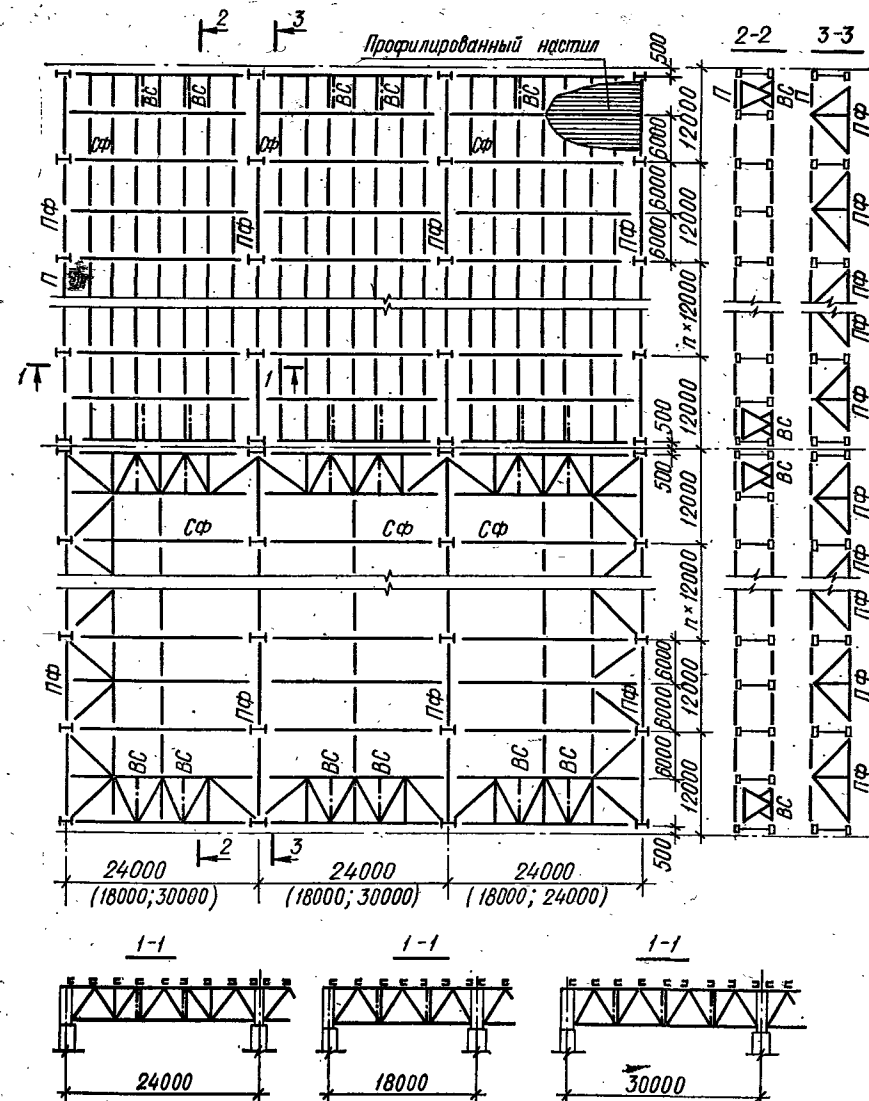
Покрытие со стропильными фермами из круглых труб (СФ — стропильная ферма; ПФ — подстропильная ферма; ВС — вертикальная связь; П — прогоны).
